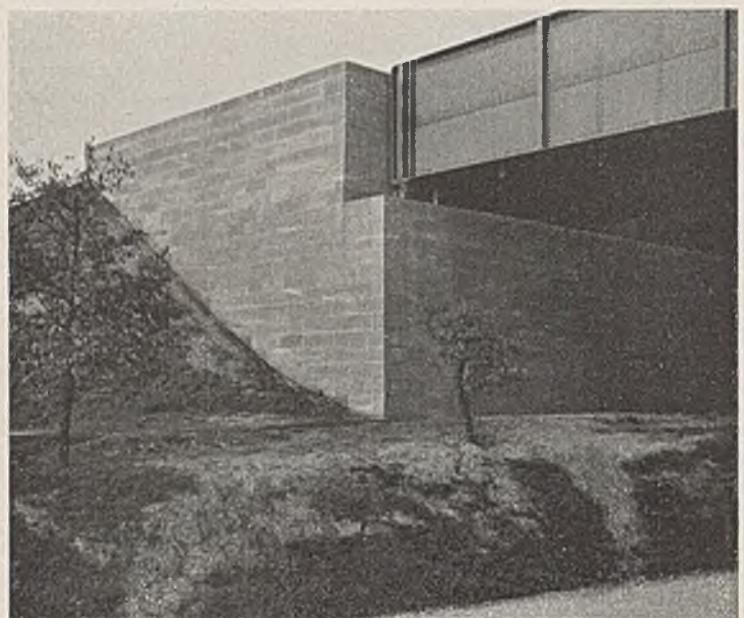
Gerade Brücke mit stählernem Überbau und mit Widerlagern mit Parallelfügeln.
